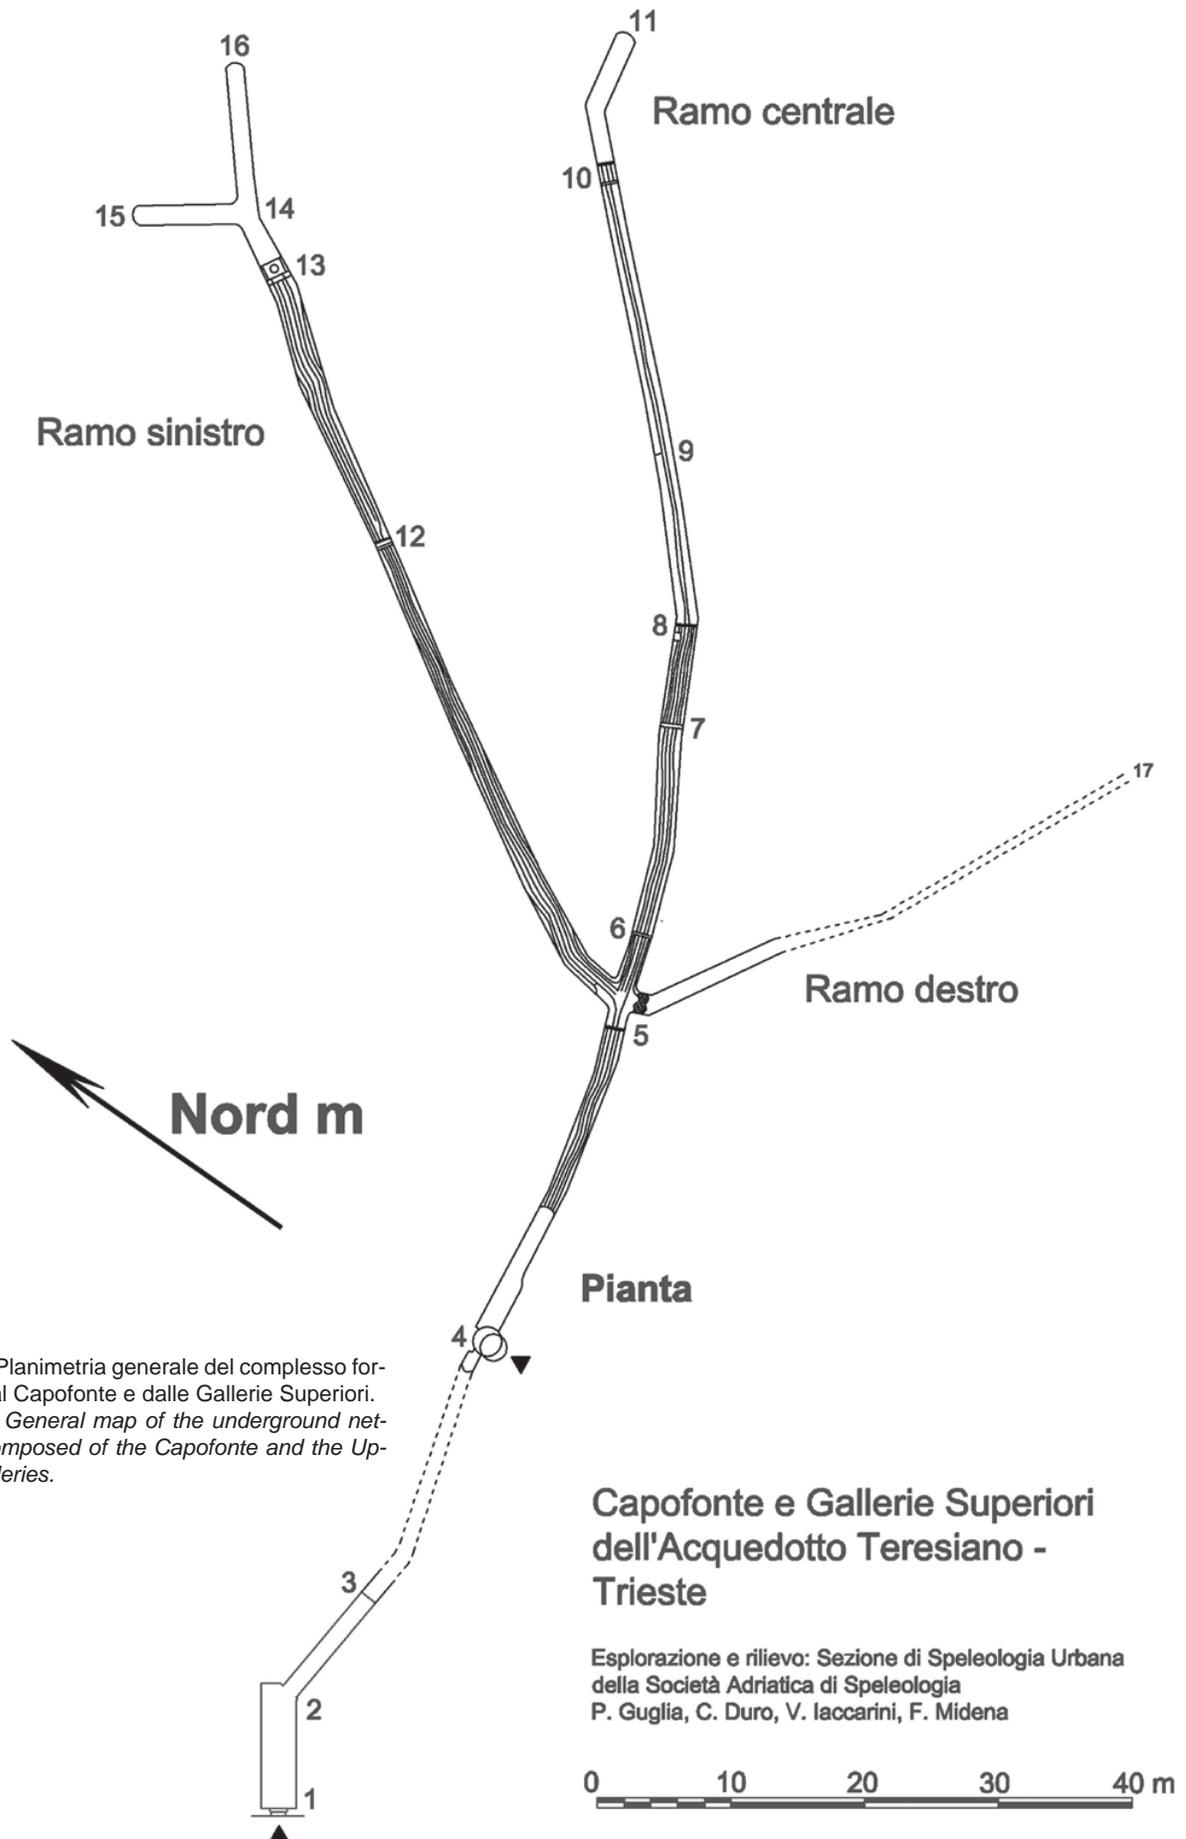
Planimetria generale del complesso formato dal Capofonte e dalle Gallerie Superiori.
